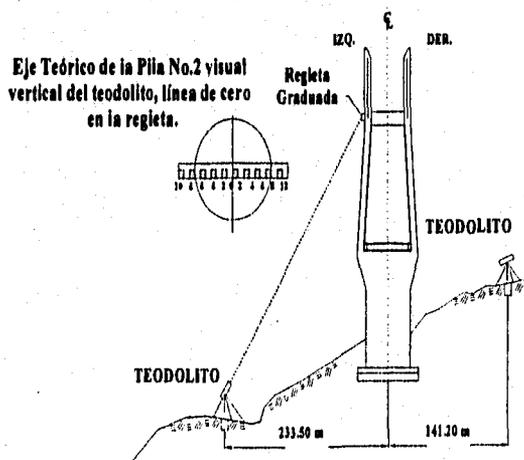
Colocación de teodolitos para el registro de los desplazamientos longitudinales del Pílon del Puente Barranca El Zapote.
